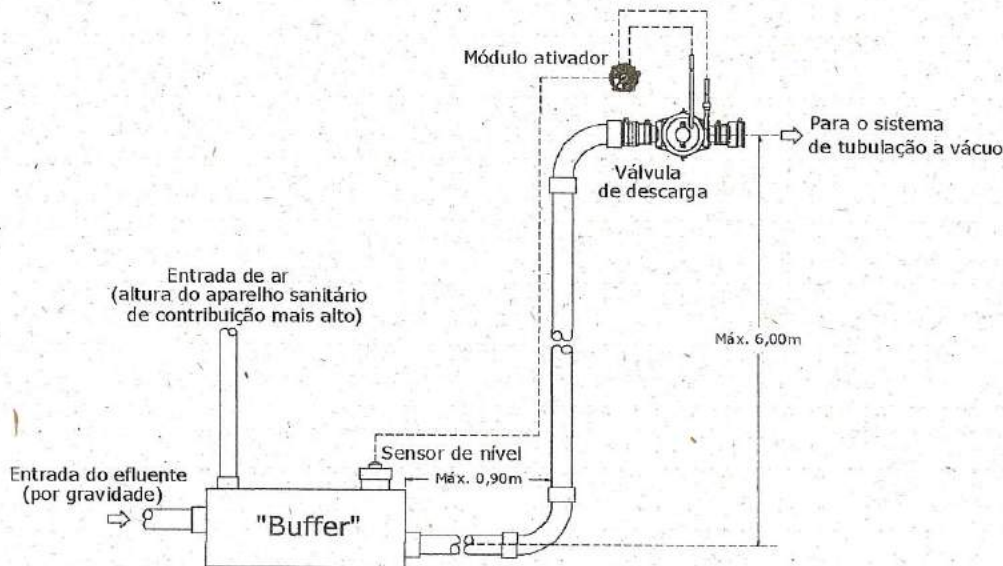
Arranjo com elevação – válvula de descarga no topo da elevação.
